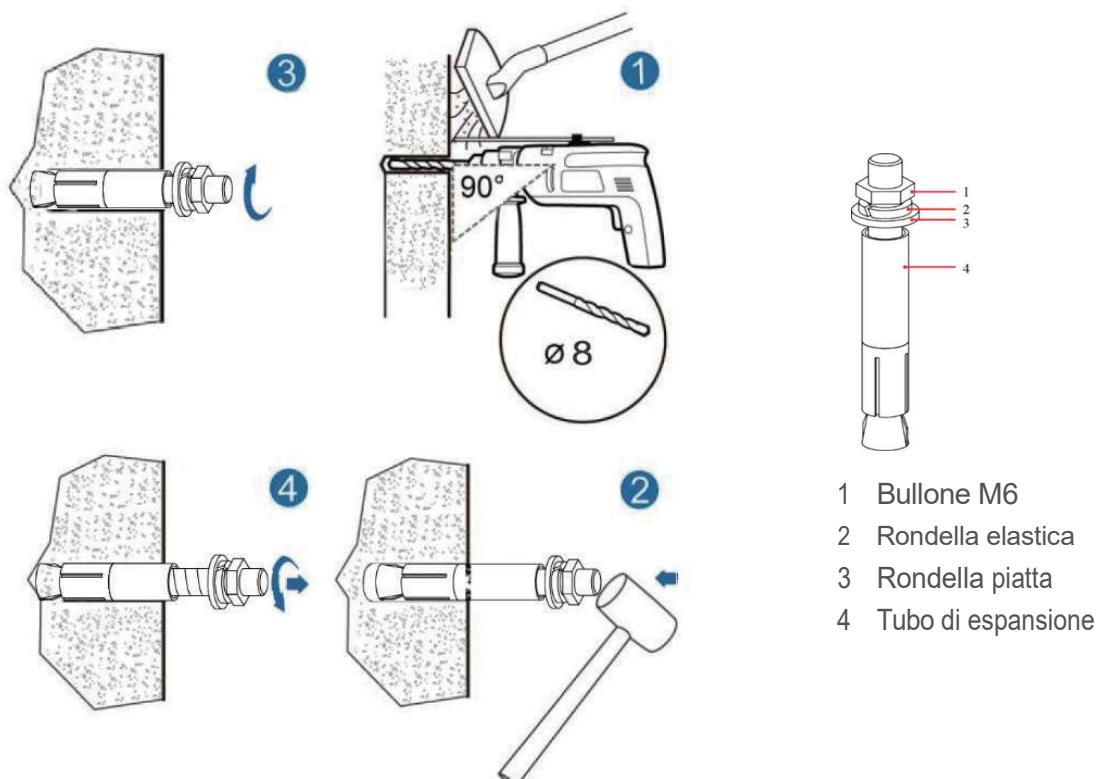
Installazione del bullone di espansione (unità: mm)
